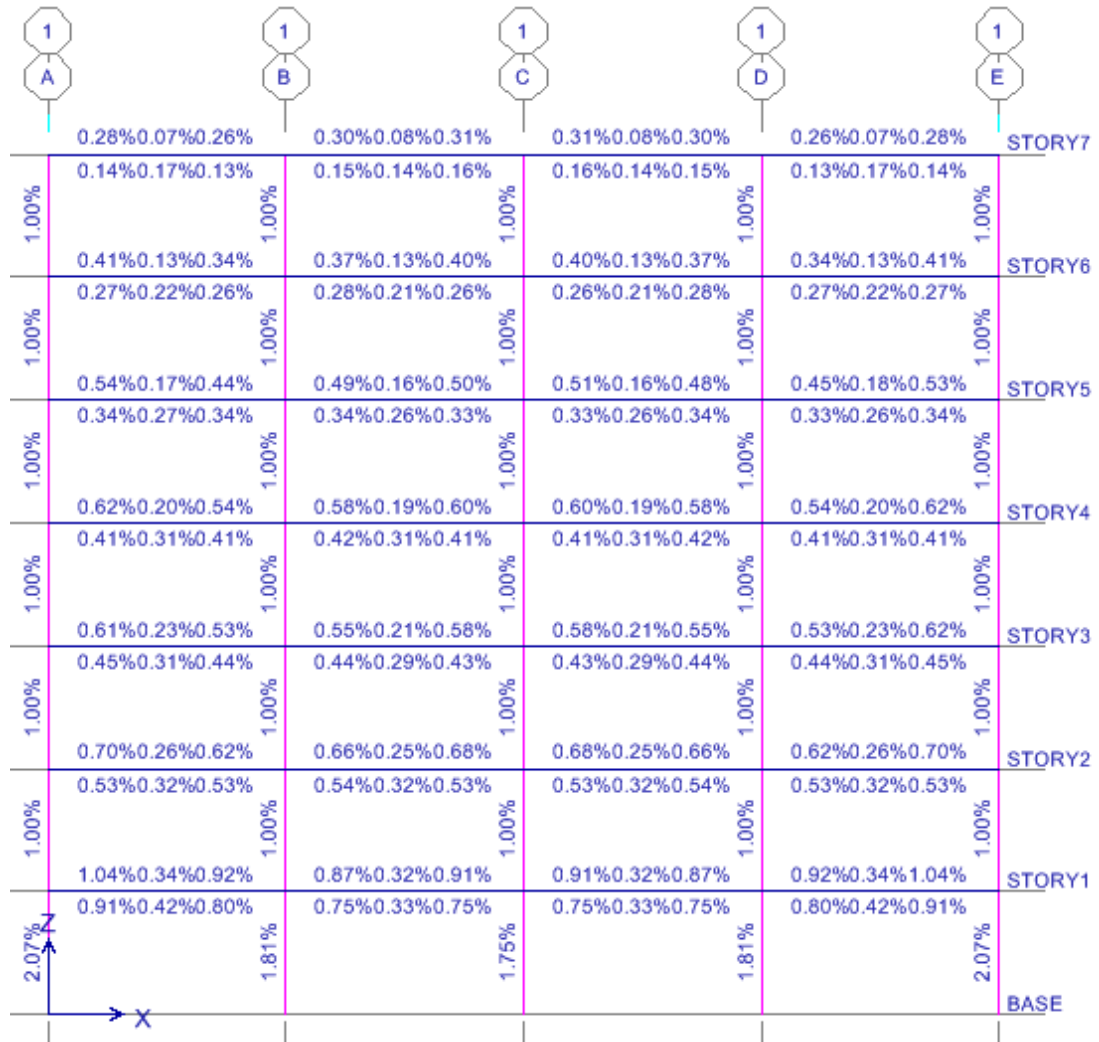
Detalle de la cuantía de refuerzo para el pórtico 1.
